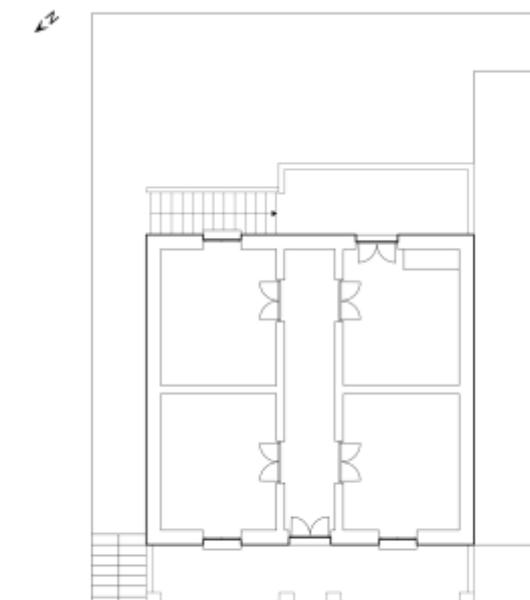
Planta do Piso 1, a habitação. (Ilustração nossa, 2021)
